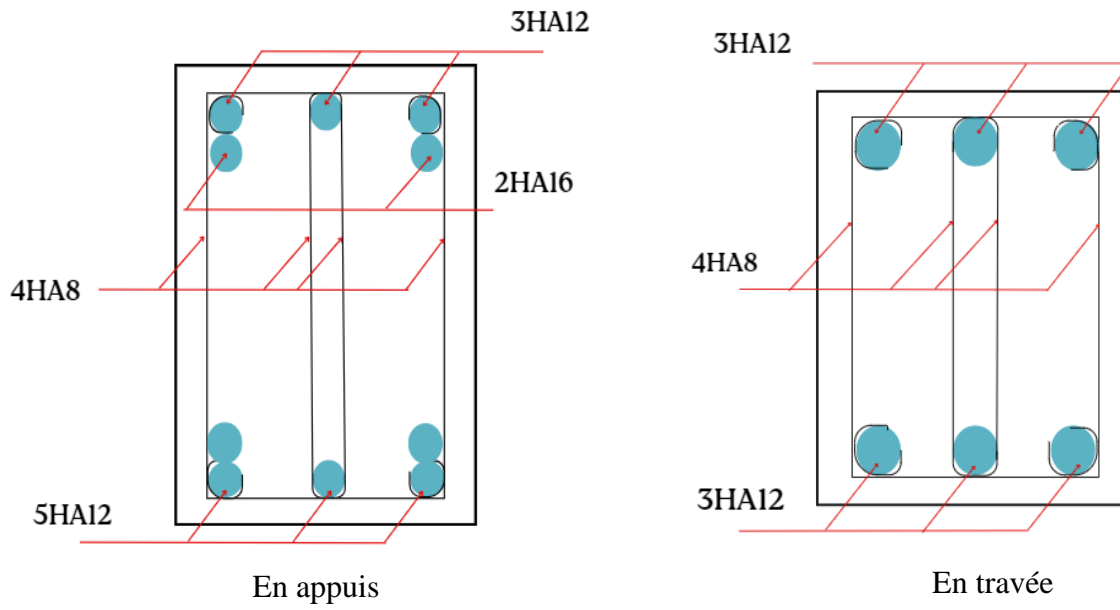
Ferraillage de la poutre secondaire 30x40
